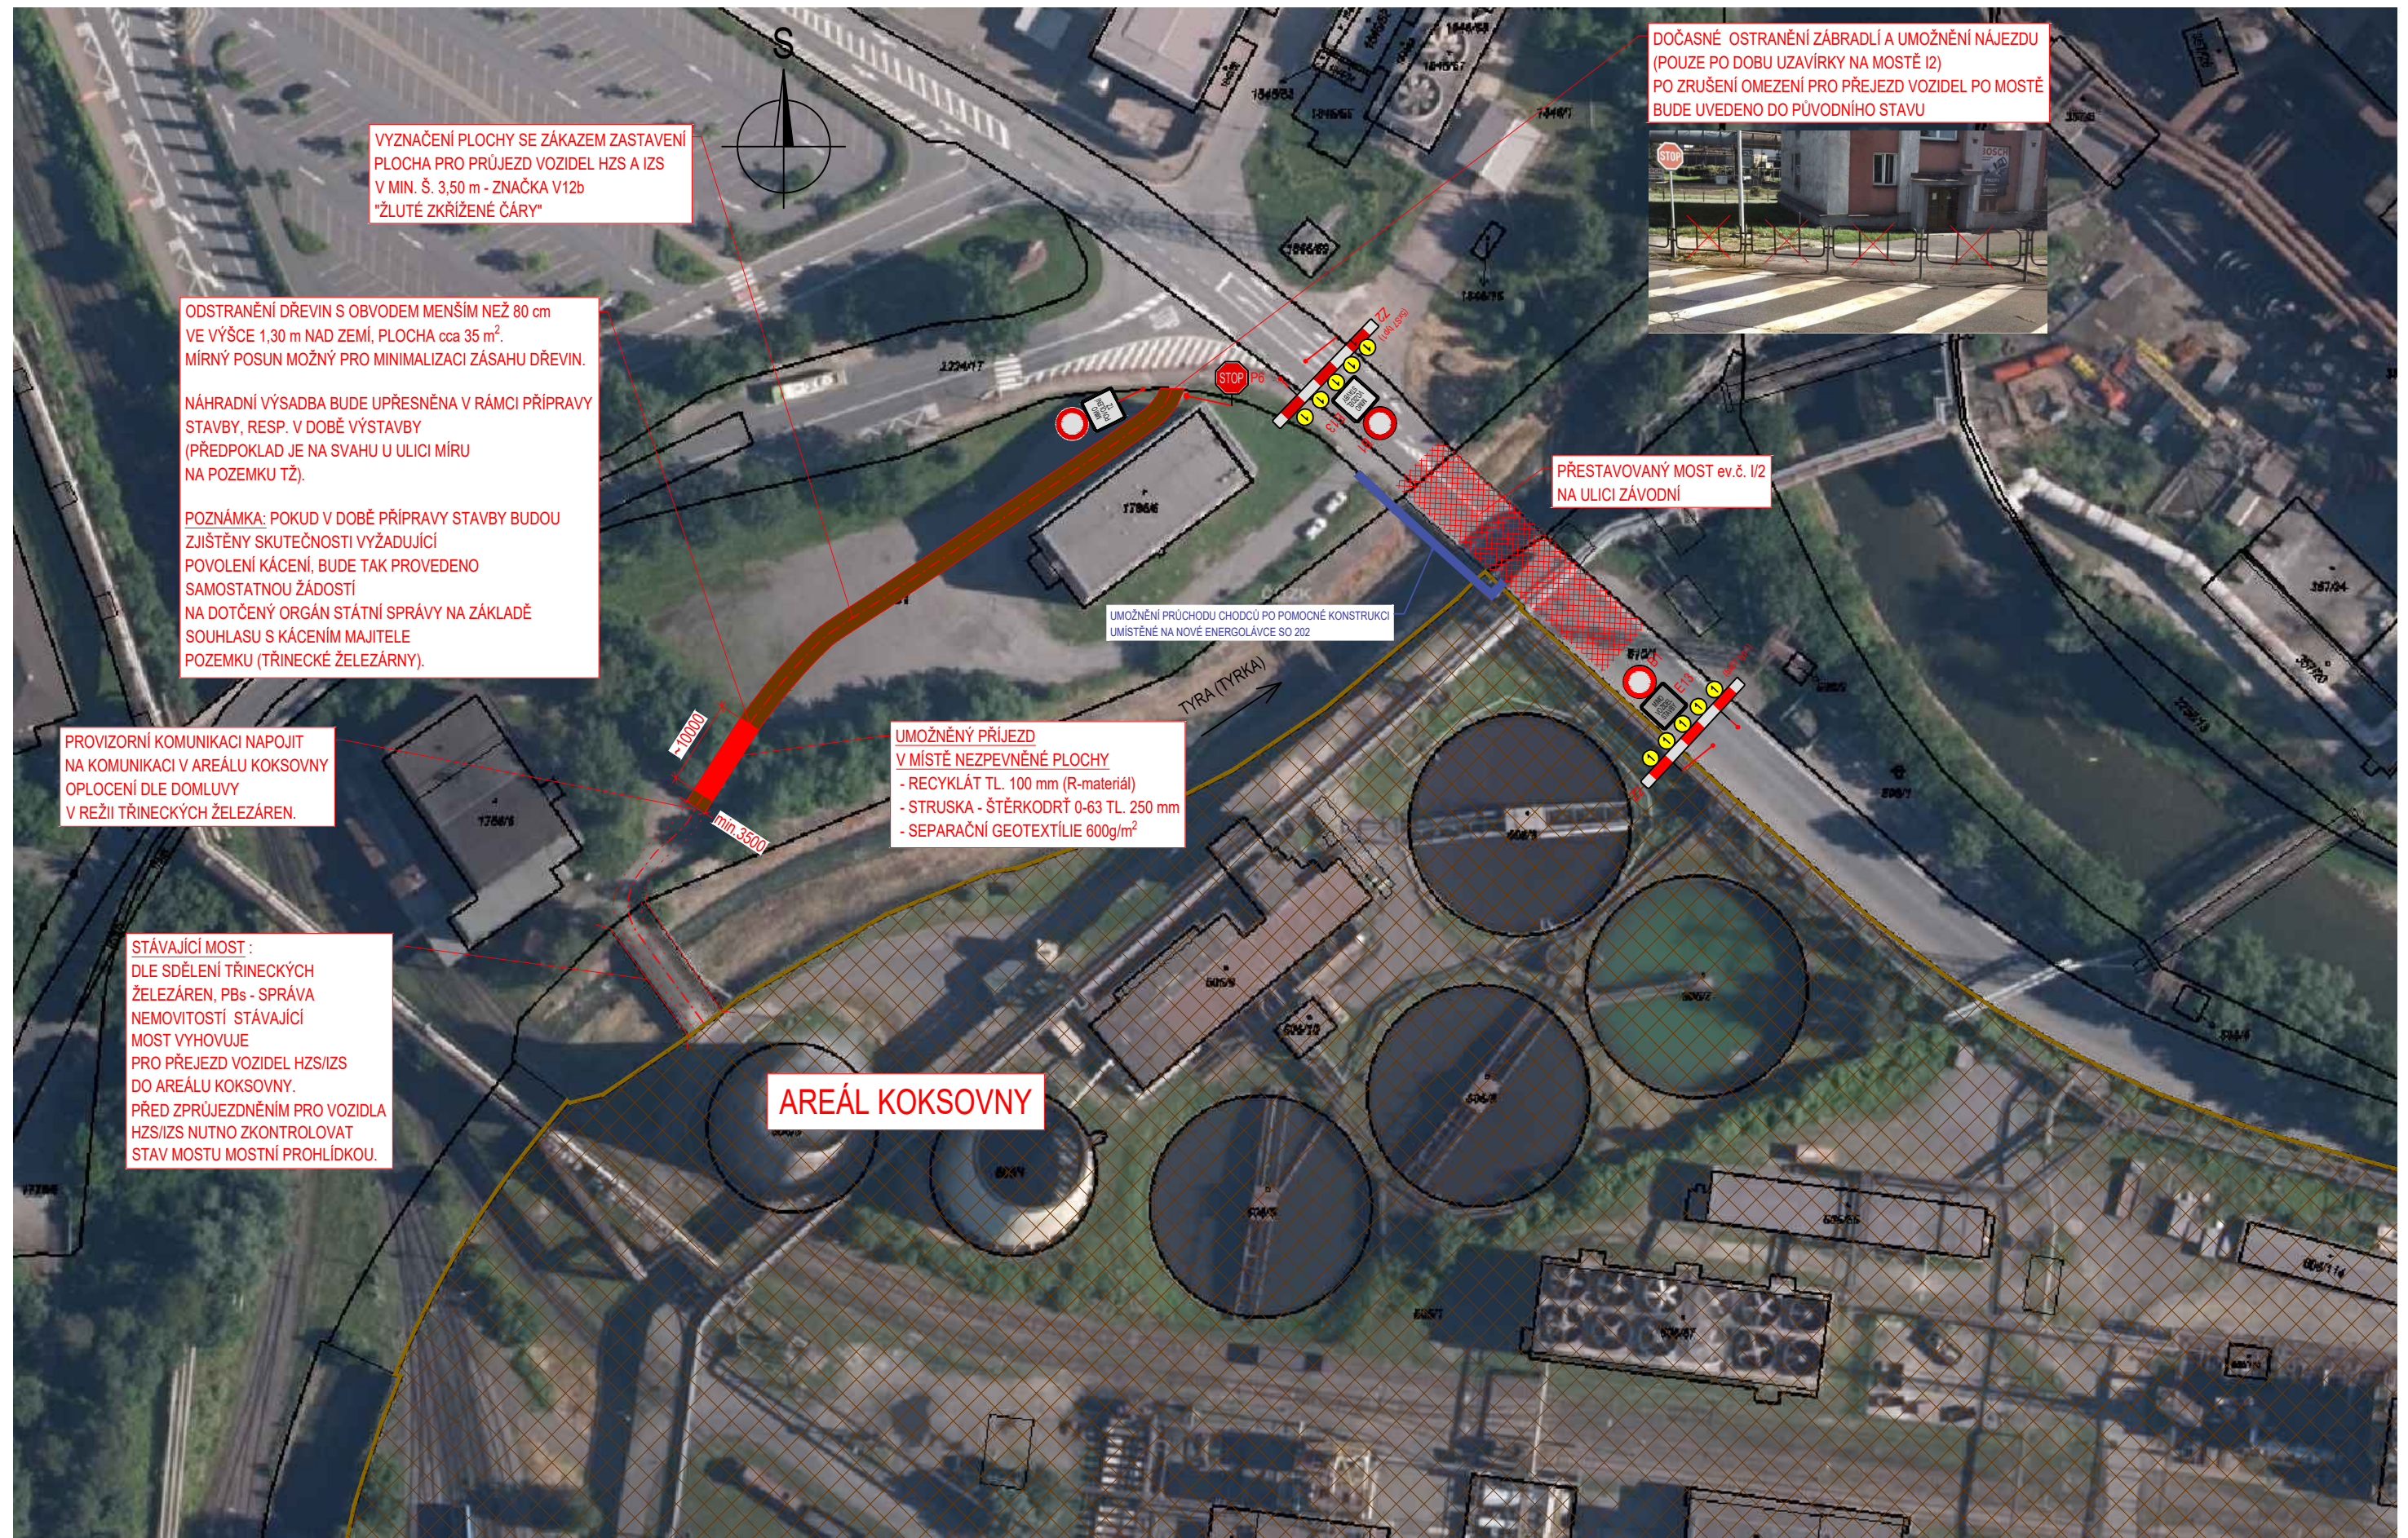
KOMPLETNÍ UZAVÍRKA
